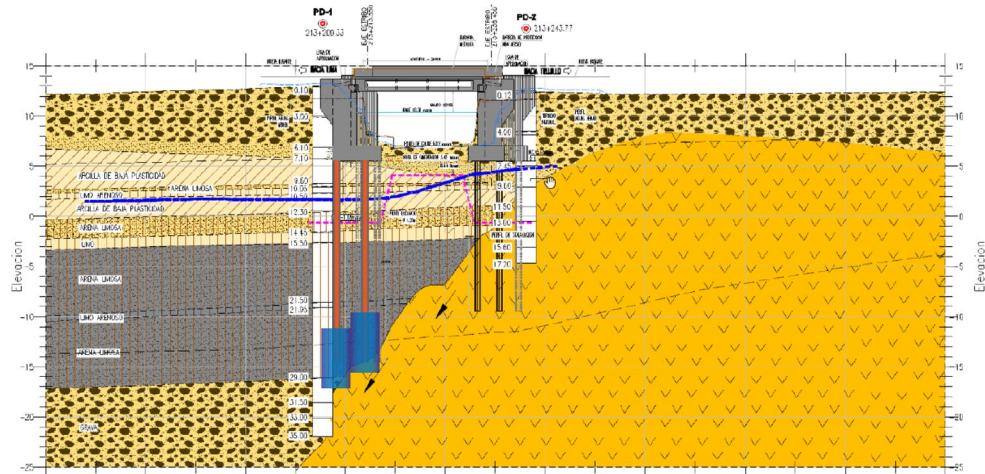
Vista pilotes con tratamiento Jet Grouting.
